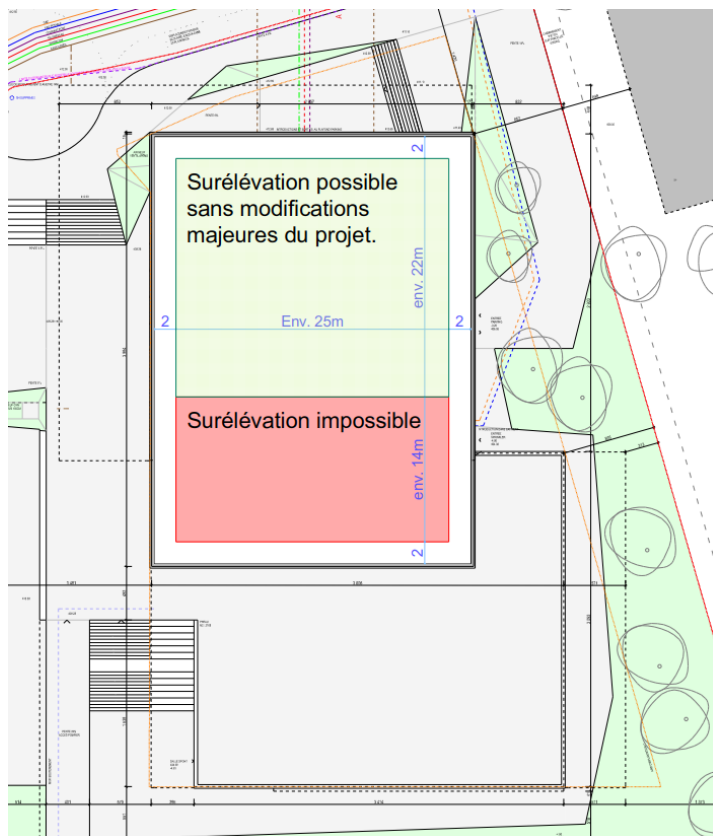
Toiture du collège Croset-Parc – Variante de surélévation sur un peu moins des deux tiers de la toiture
